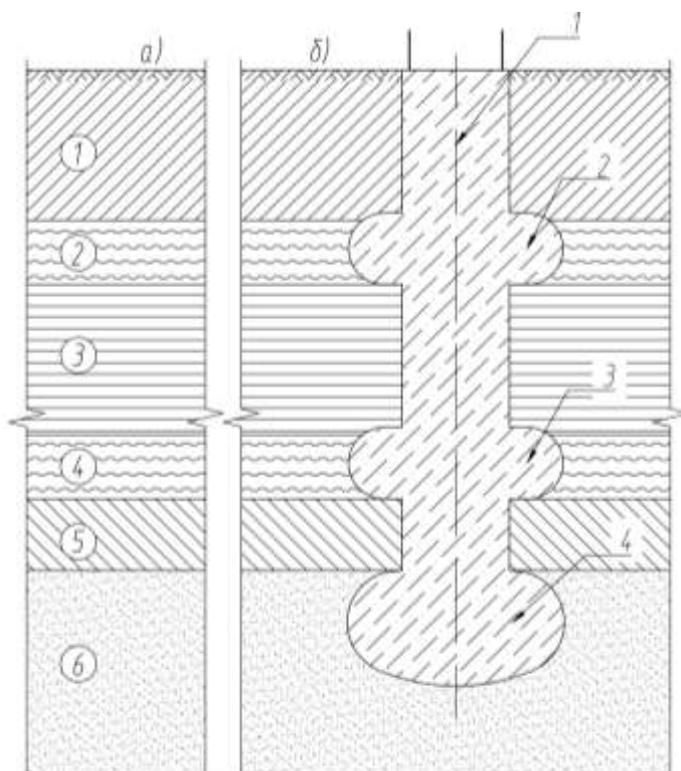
Врезка в инженерно-геологический разрез буровой грунтобетонной сваи с множественными уширениями:
